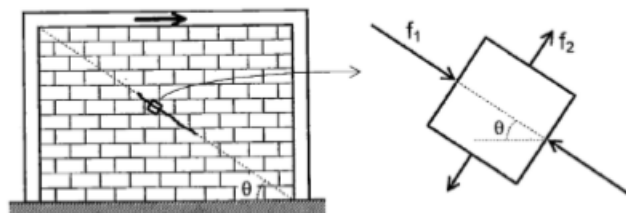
Falla a tracción diagonal generada por un esfuerzo de compresión y tensión paralela al panel de mampostería.
